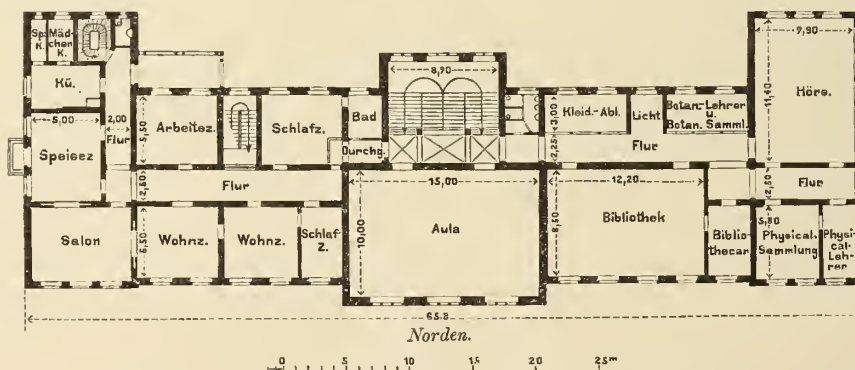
Grundriss des Obergeschosses vom Hauptgebäude.
